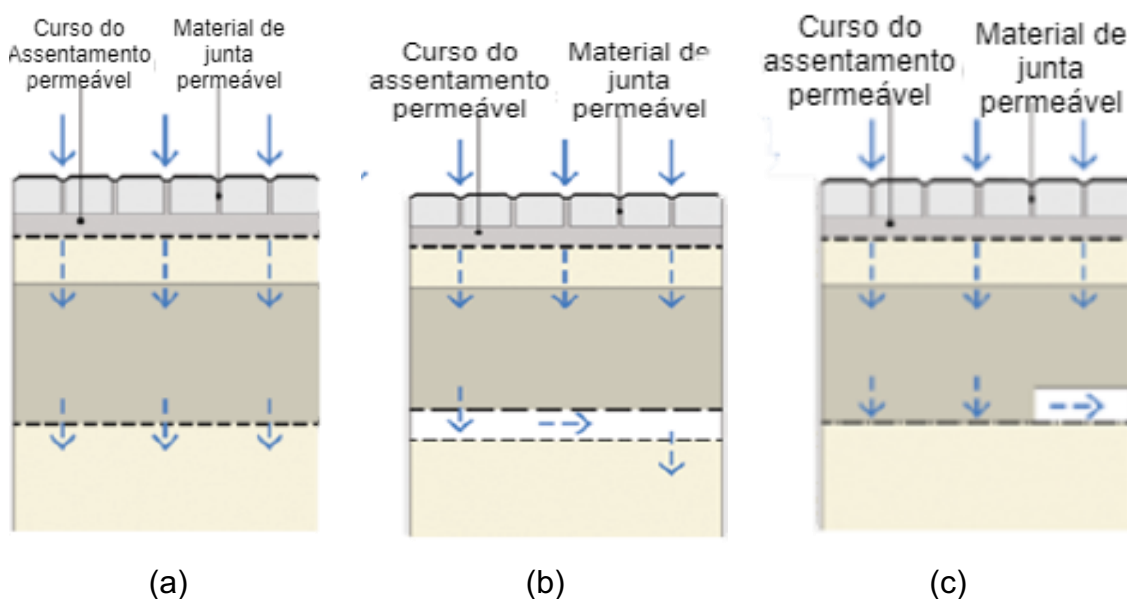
Tipos de sistemas de pavimentos permeáveis: (a) Infiltração total; (b) Infiltração parcial e (c) Sem infiltração
